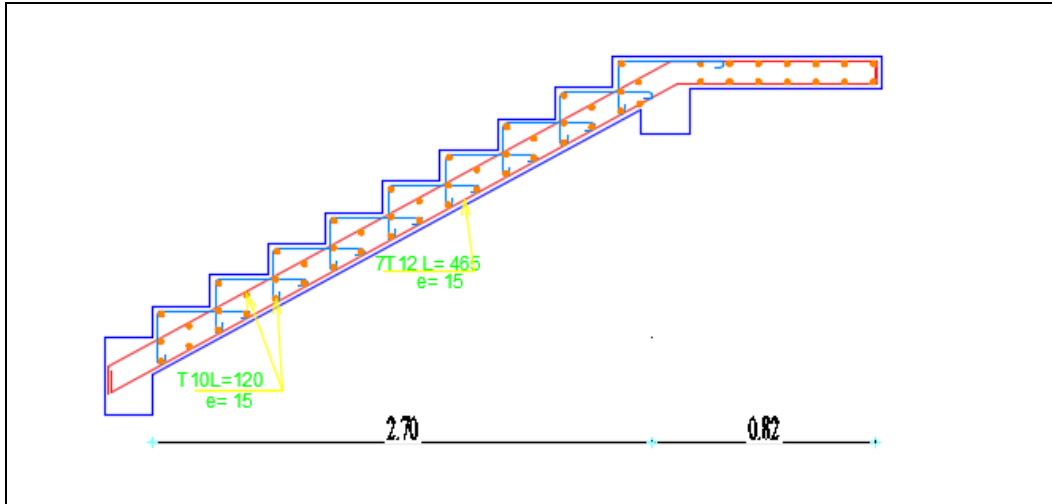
schéma de ferrailage de l'escalier (RDC)
